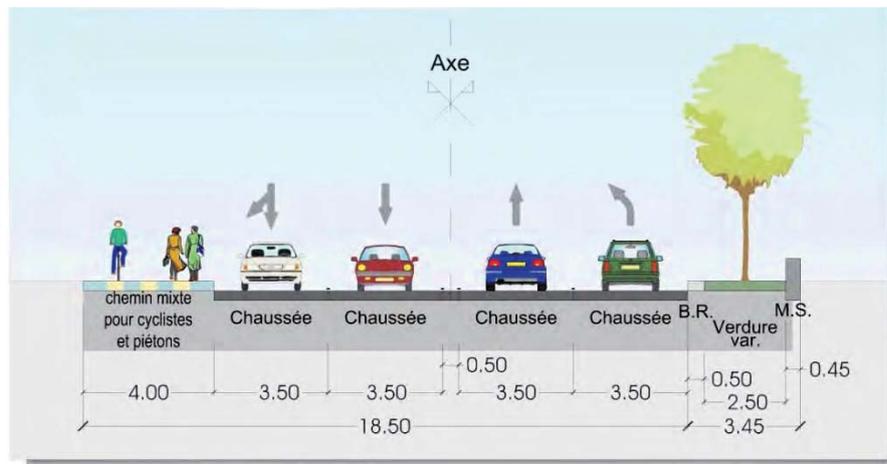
Coupe type de la N7 avant l'ouvrage Patton en direction du carrefour „Dreieck“
